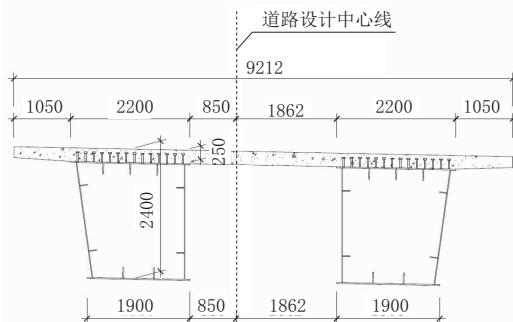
匝道 43m+44m 连续组合梁断面图(单位:mm)
